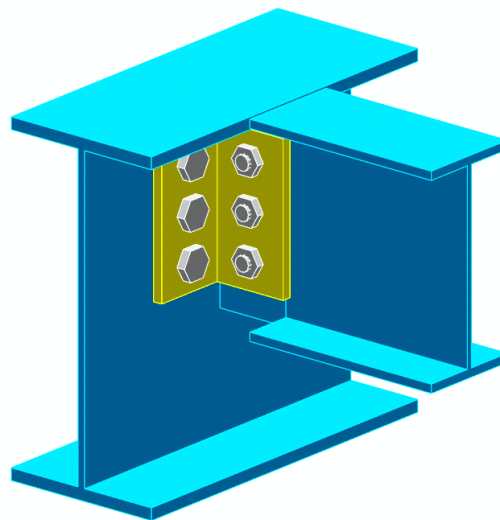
Vue 3D de l'assemblage poutre principal solive
